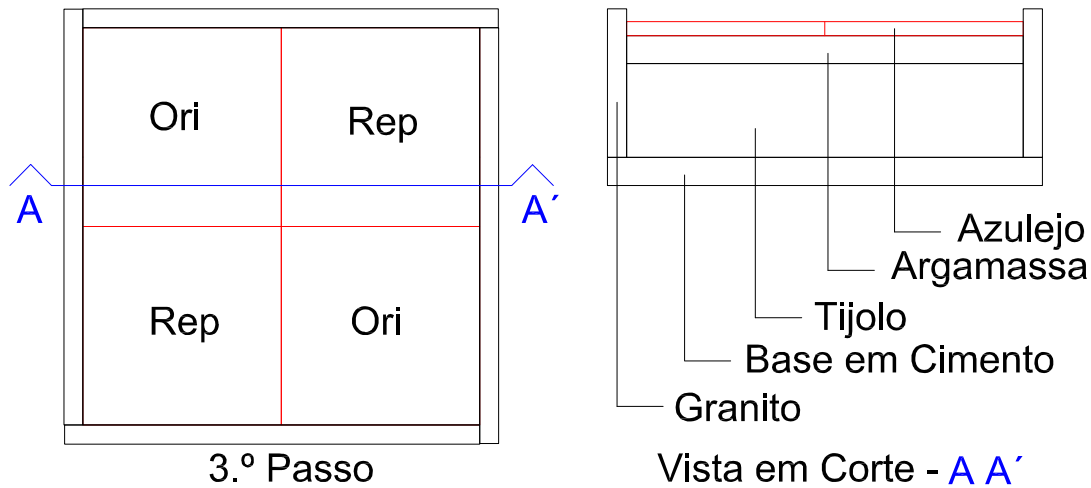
Esquema de montagem, 3.º passo e vista em corte
